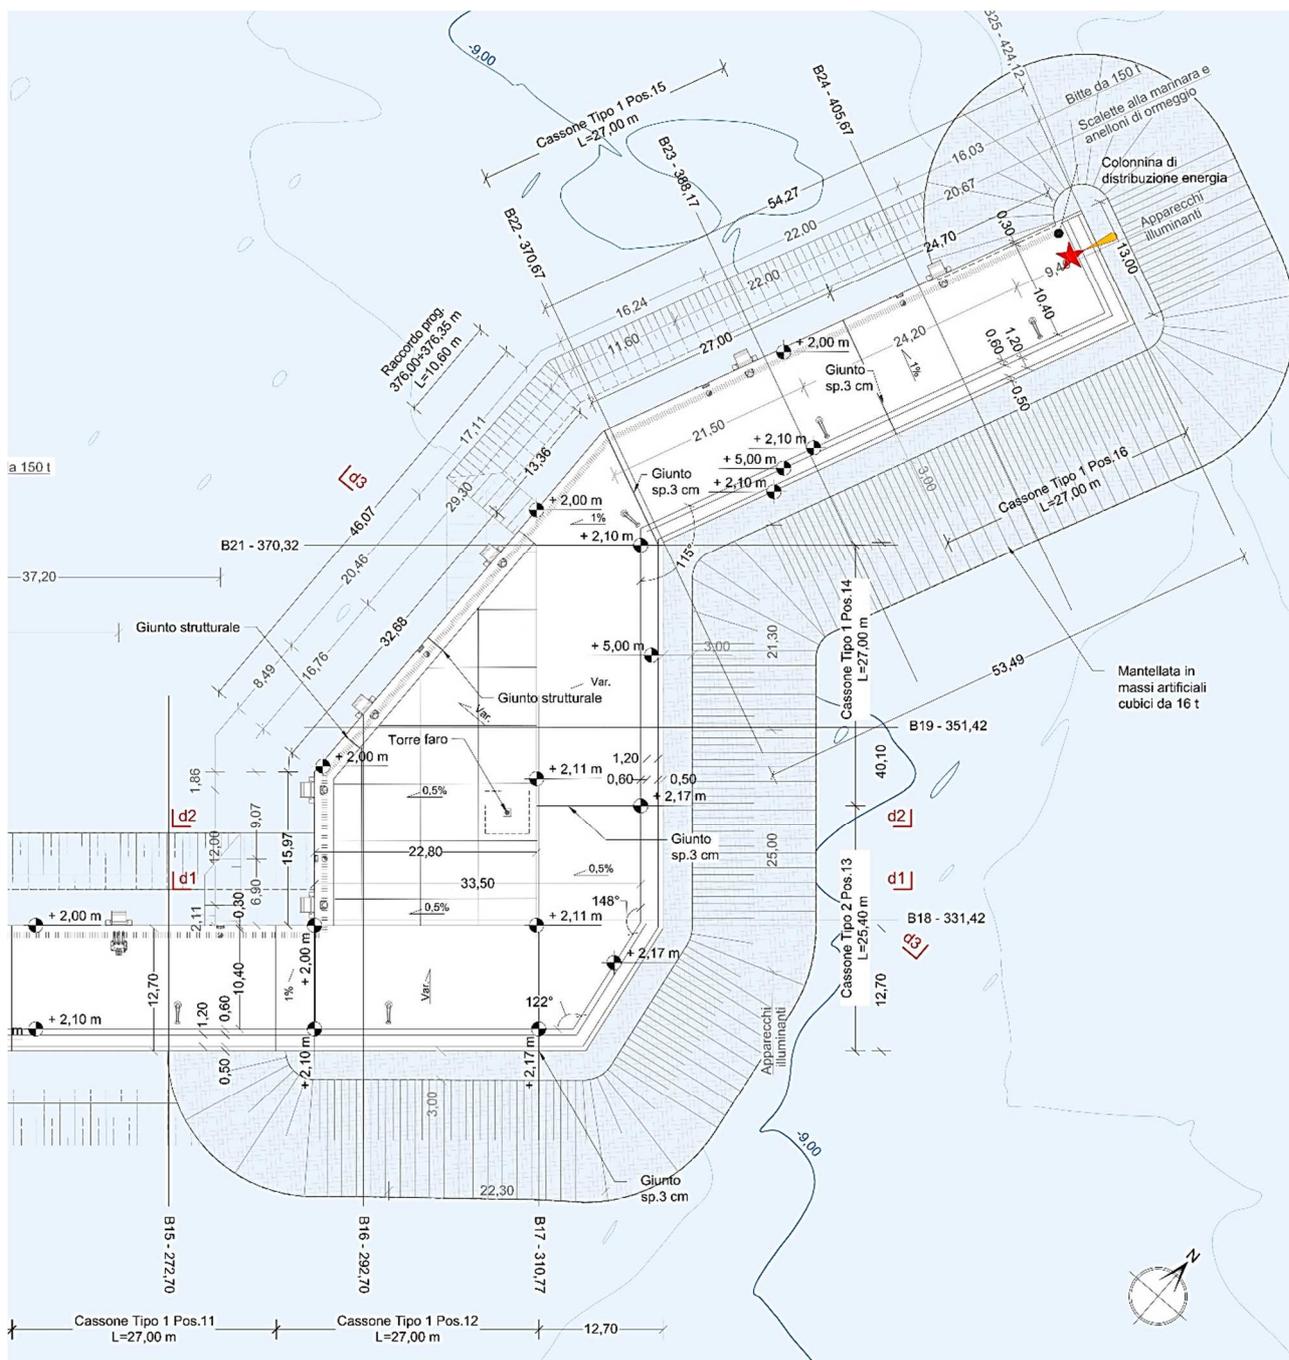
Piazzale in testa alla Diga di Sottoflutto: Planimetria al finito
